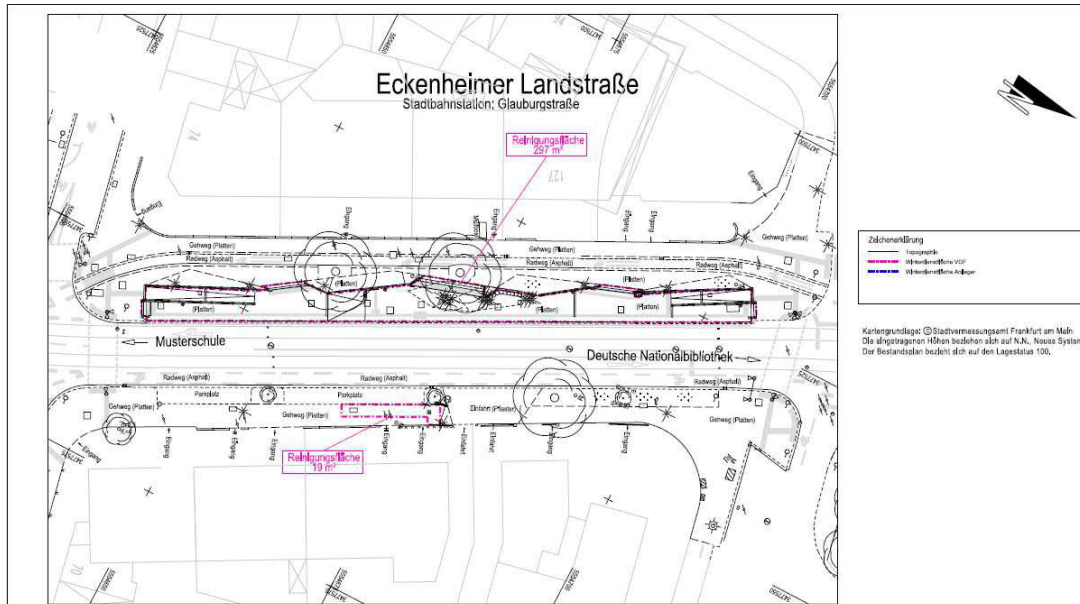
WD-Plan der Station Glauburgstraße GB.2.1 (Anmerkung: auf diesem Plan ist auch die SEV-Haltestelle GB.4.1 enthalten)
